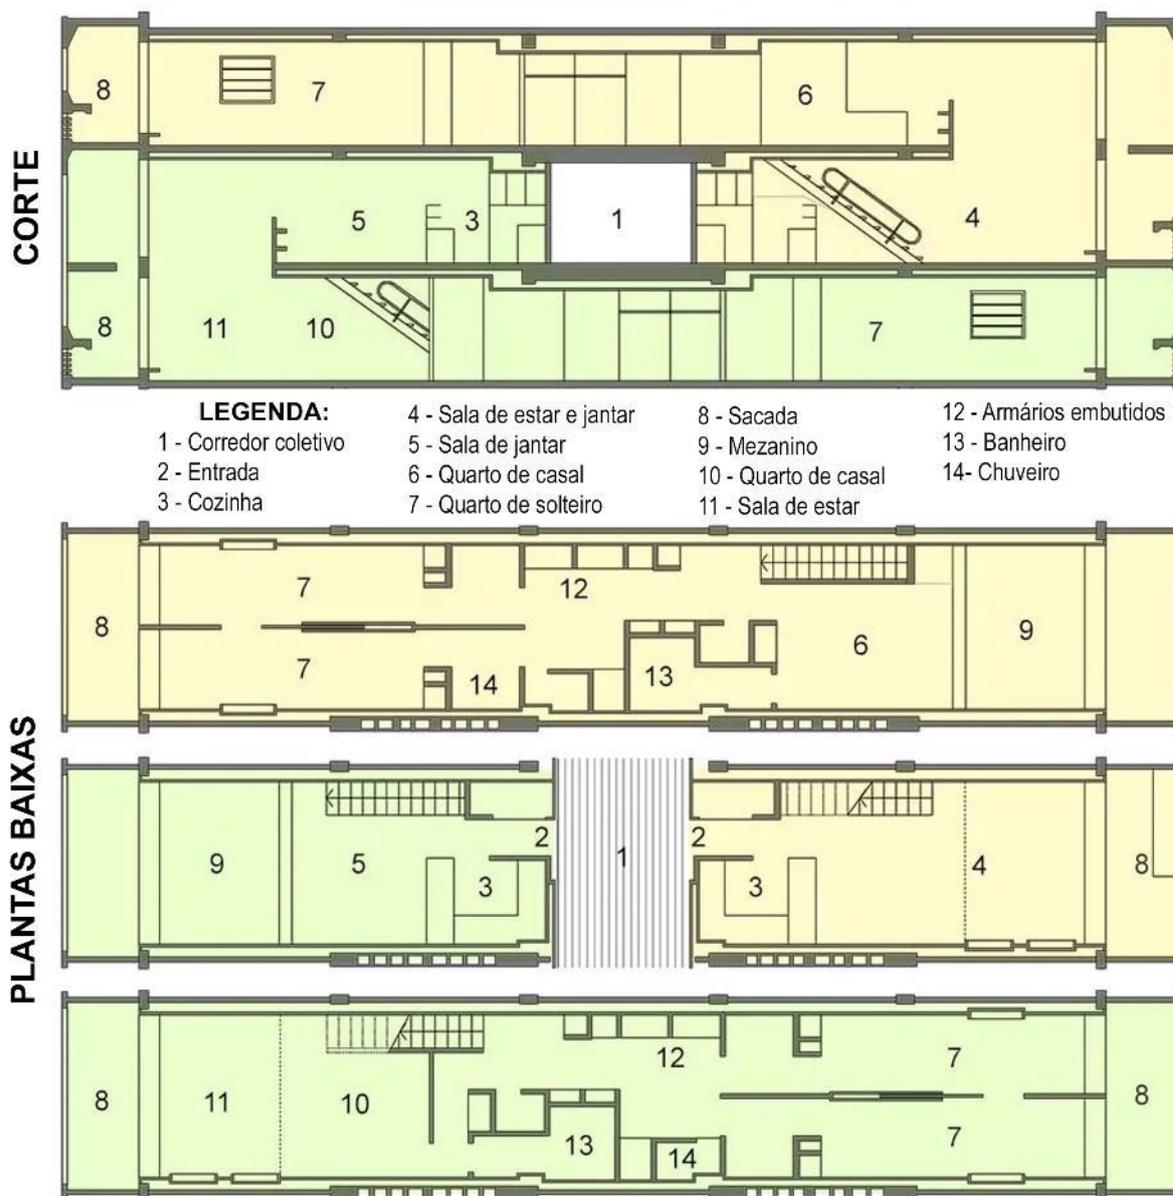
Unidade de Habitação de Marselha – Corte e plantas baixas - (fonte: <https://www.inexhibit.com/>)
